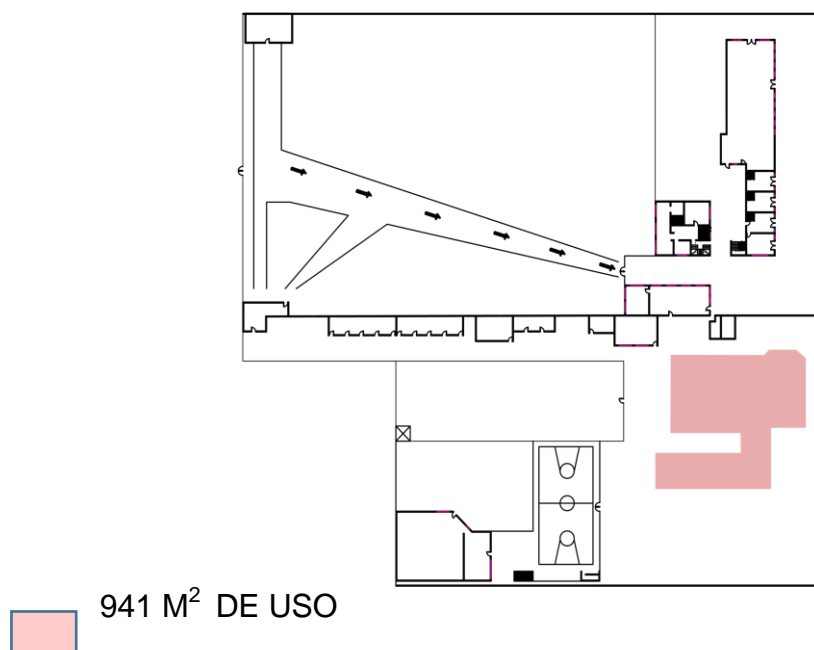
Implantación de espacio para el proyecto en la fundación Laura Vicuña
